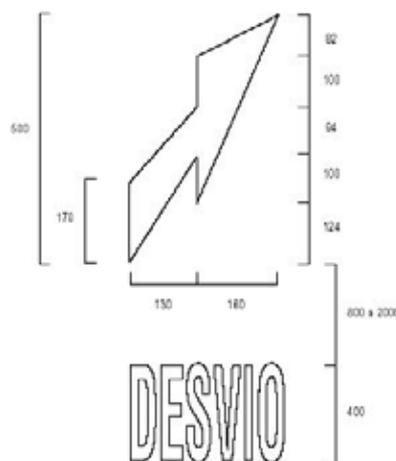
Tipo de marca de pavimento que indica “ Desvío”
